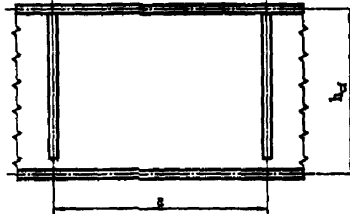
Схема к расчету устойчивости стенки балки
